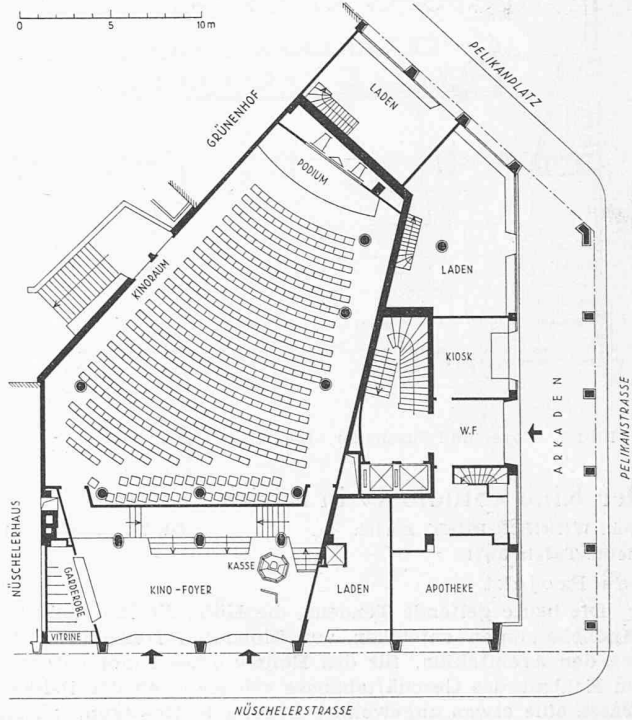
Erdgeschoss mit Kinoraum und Läden, 1 : 400
